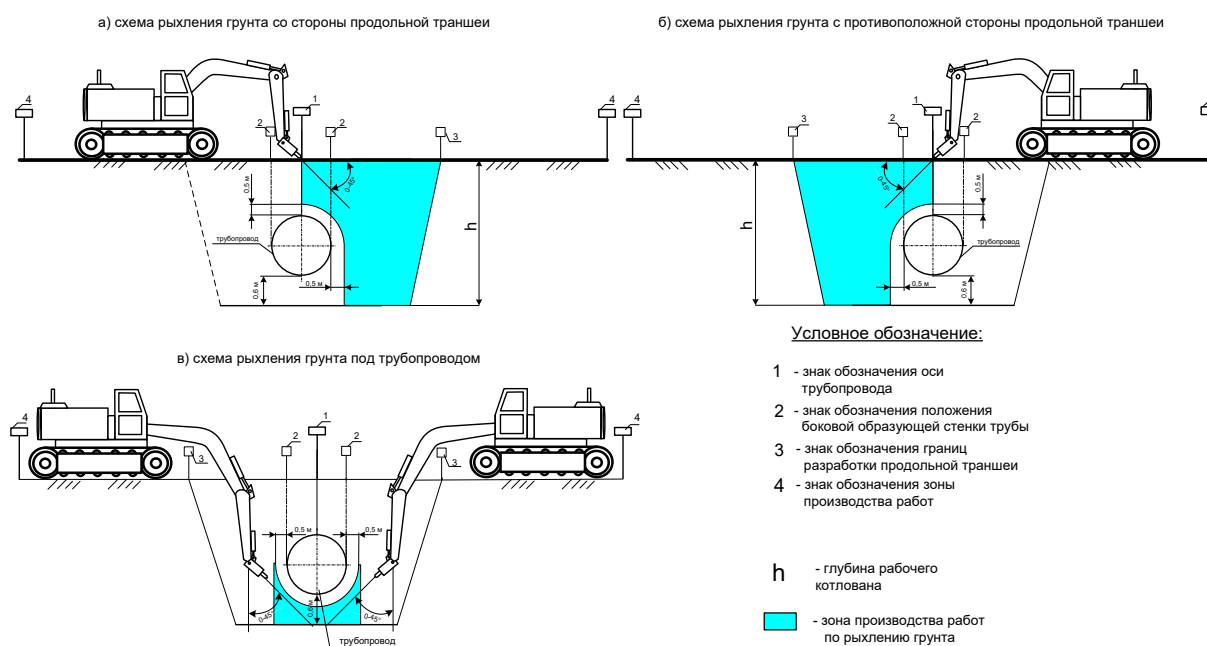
Схема производства земляных работ гидравлическим молотом
